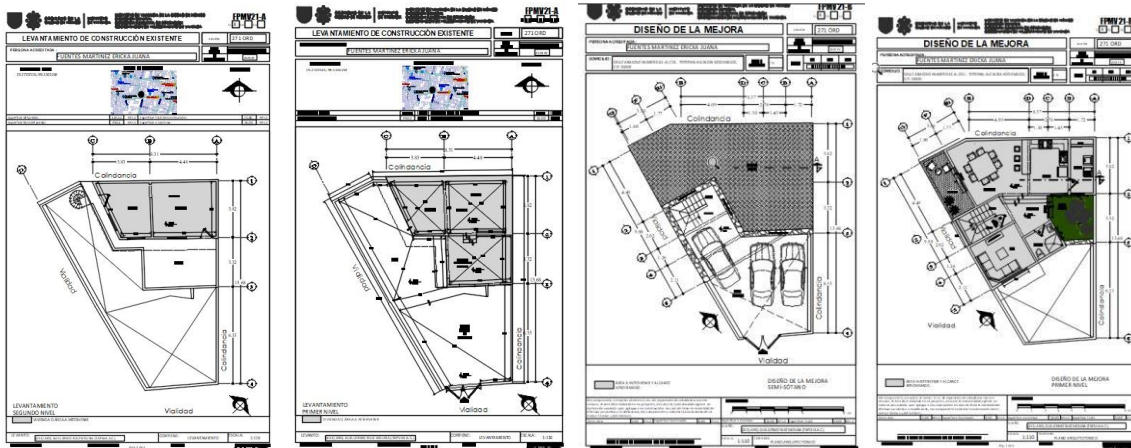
Planos de levantamiento, y diseño arquitectónico y ejecutivos.
